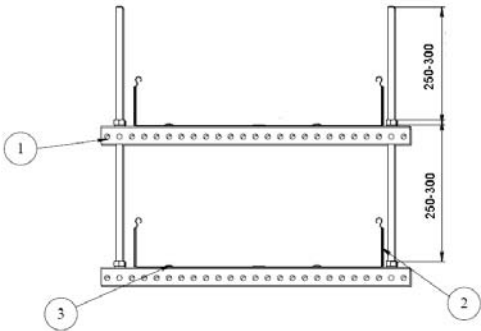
Вид подвеса (1 – П-образный профиль ВРМ; 2 – кабельный лоток; 3 – место крепления лотка к профилю)
